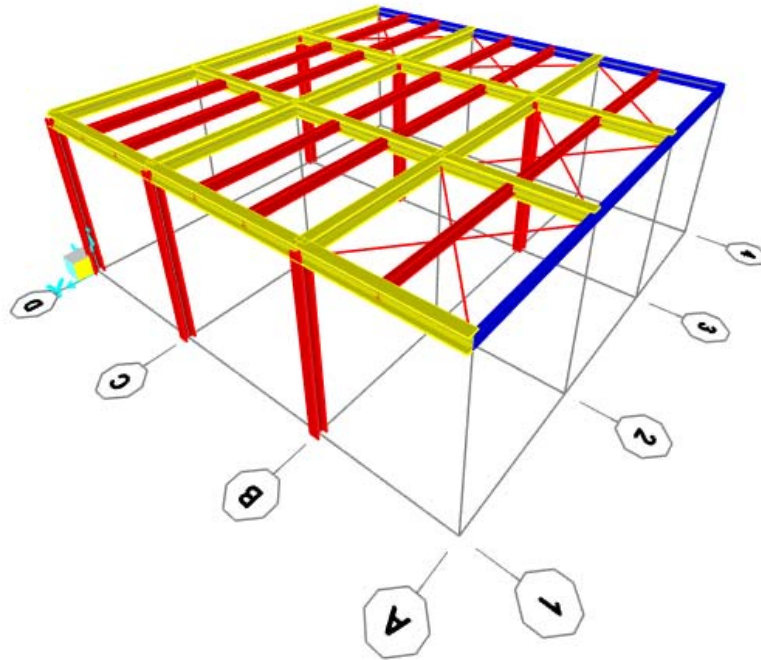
Vista assonometrica modello struttura in elevazione - elementi estrusi
